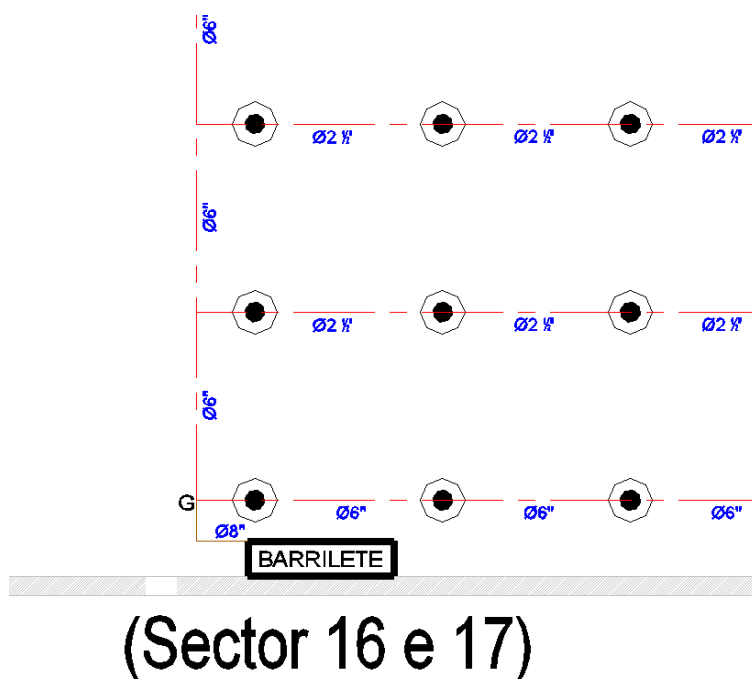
Zoom da área de pormenor 2 (coluna e barrilete).
